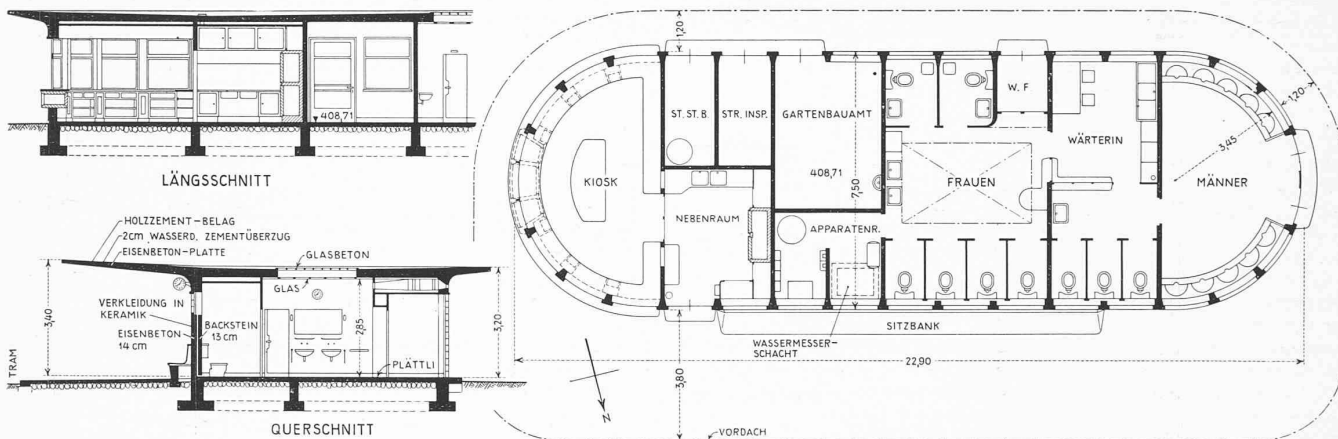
Schnitte und Grundriss des Dienstgebäudes am Bellevueplatz. Arch. Stadtbaumeister H. Herter. — Masstab 1 : 200
